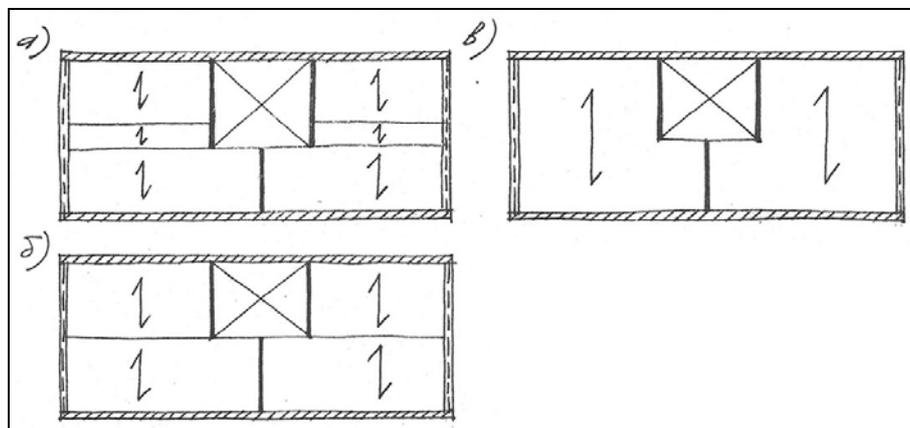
Продольно-стеновые конструктивные системы с перекрытиями:
